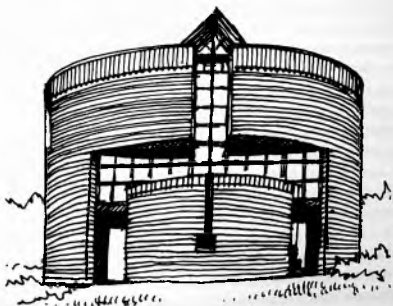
Casa em Stabio (Rotonda): Mário Botta
